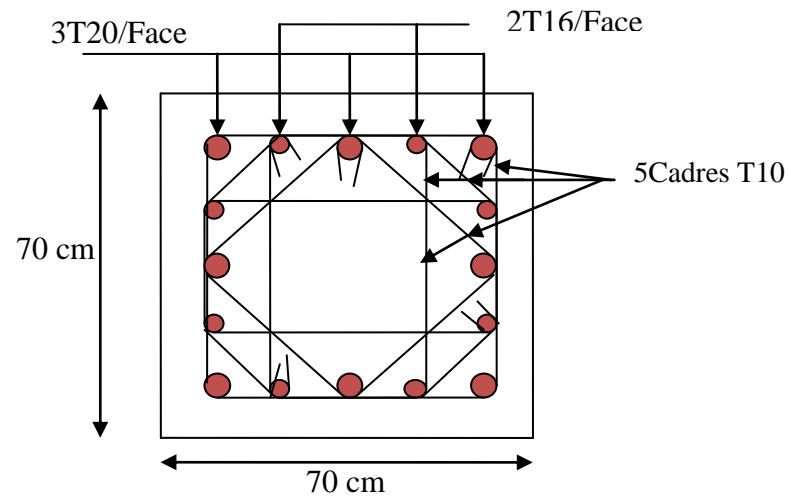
Schéma de ferrailage des poteaux d'E.S.1, ES2
